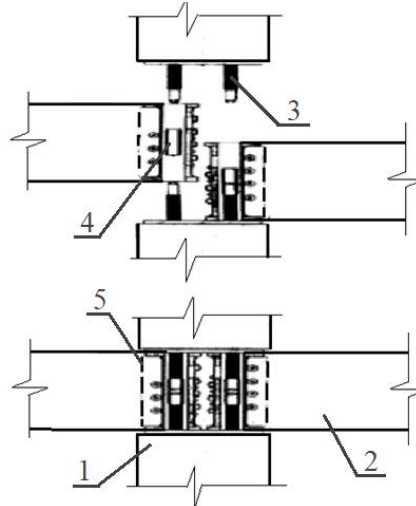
Узел сопряжения колонн с плитами перекрытия системы «CD20»
